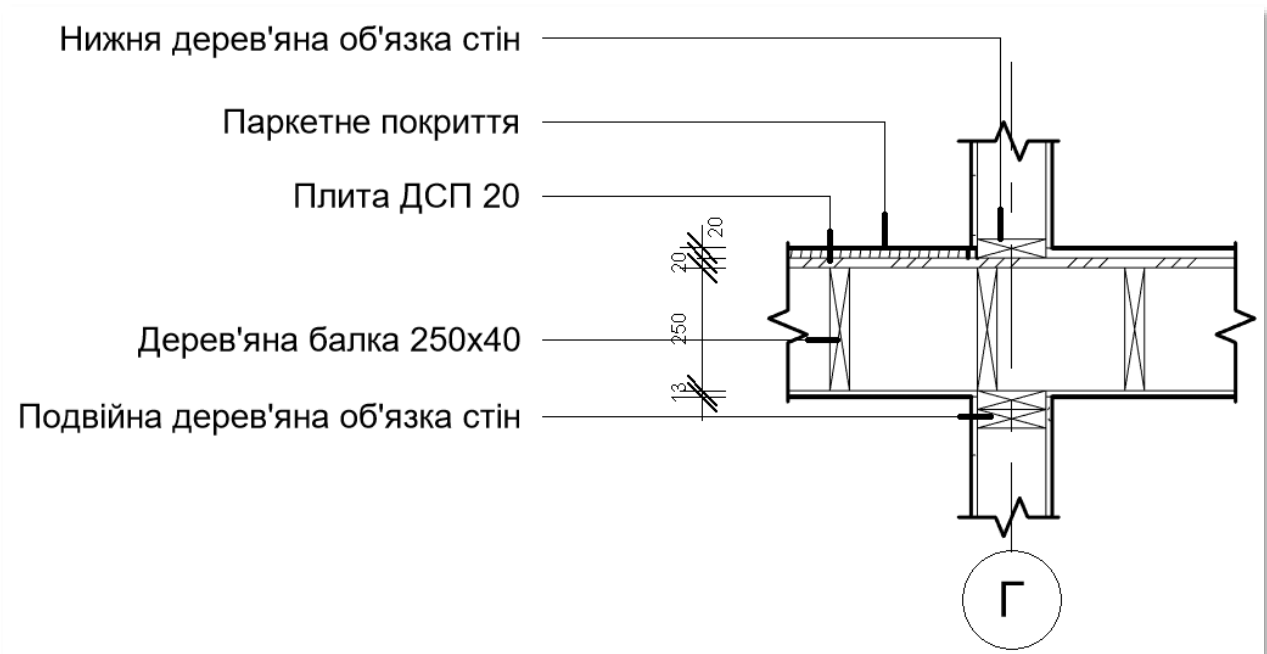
Вузол з'єднання перекриття зі стінами
